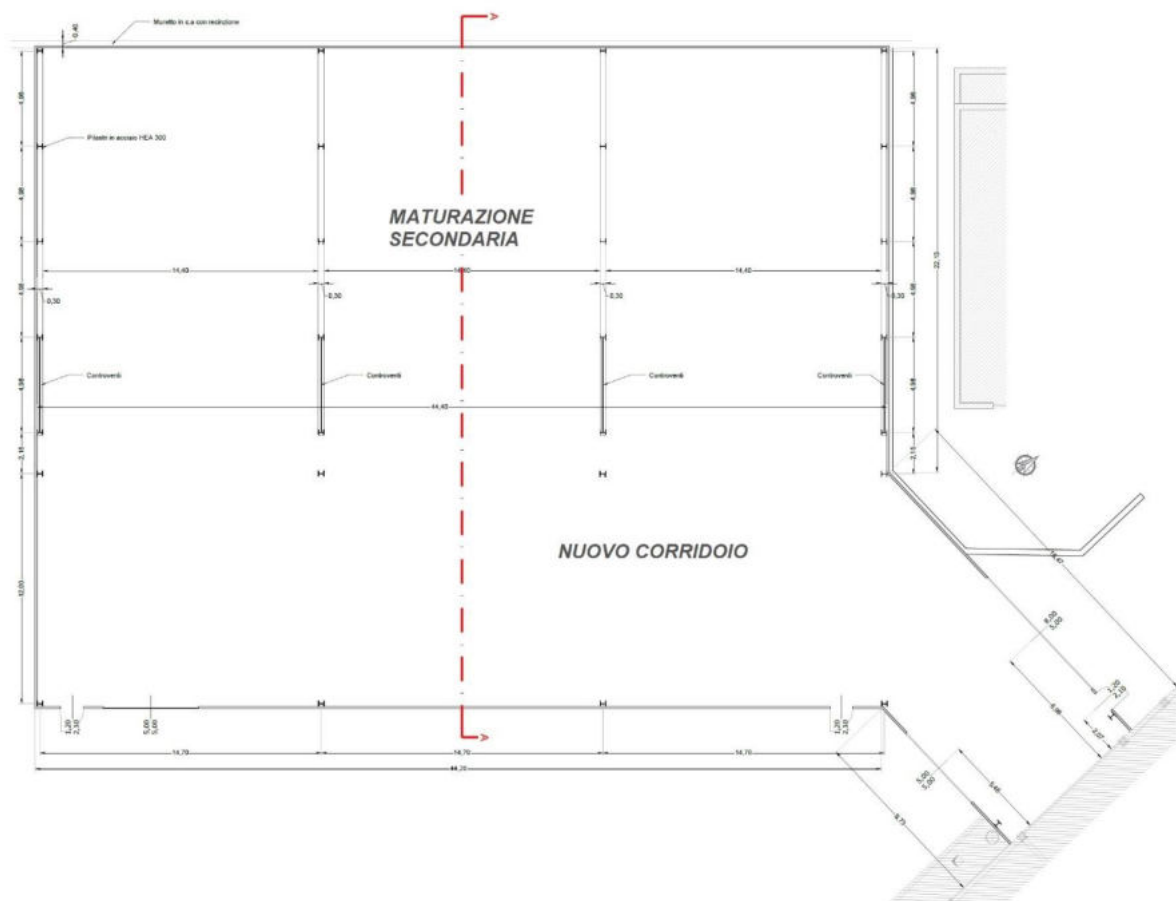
PIANTA DI DETTAGLIO – Interventi sulla tettoia di Maturazione Secondaria e Nuovo Corridoio
